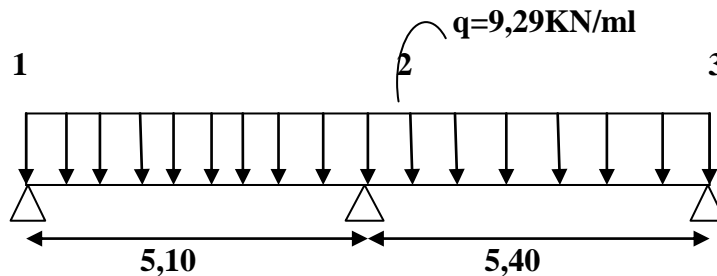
la poutrelle type 2 de la terrasse accessible.
